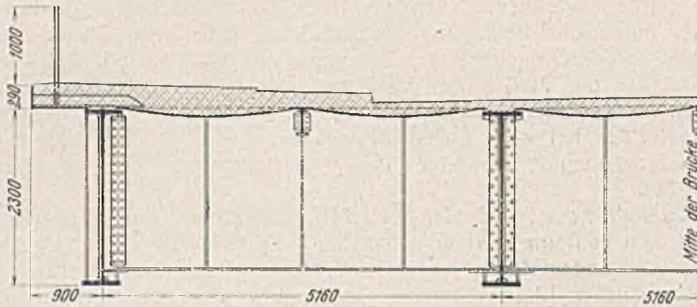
Überführung der Fernstraße Berlin—Schwanebeck. Querschnitt.
